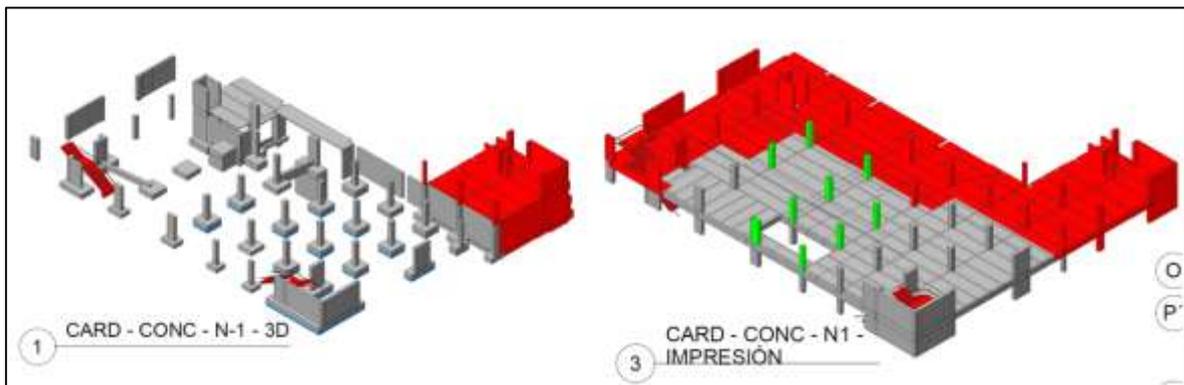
Trabajos ejecutados hasta el 18/01/2020
